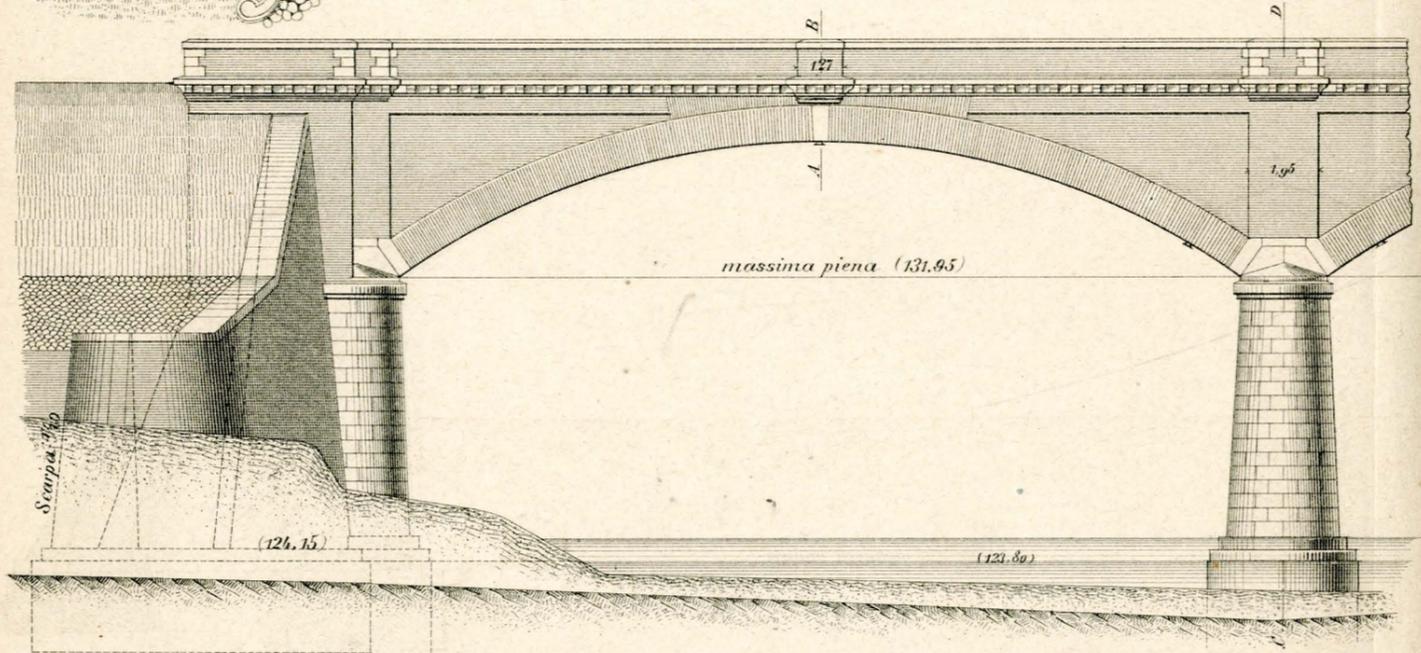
Sectione longitudinale verso la spalla destra.
